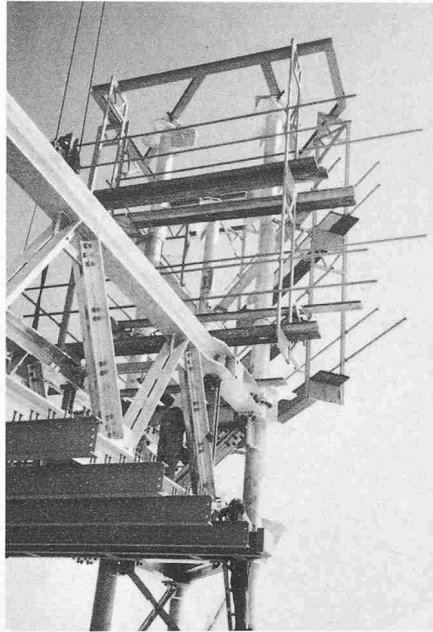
Hängegerüst für die Montage der Stützensaufachung
